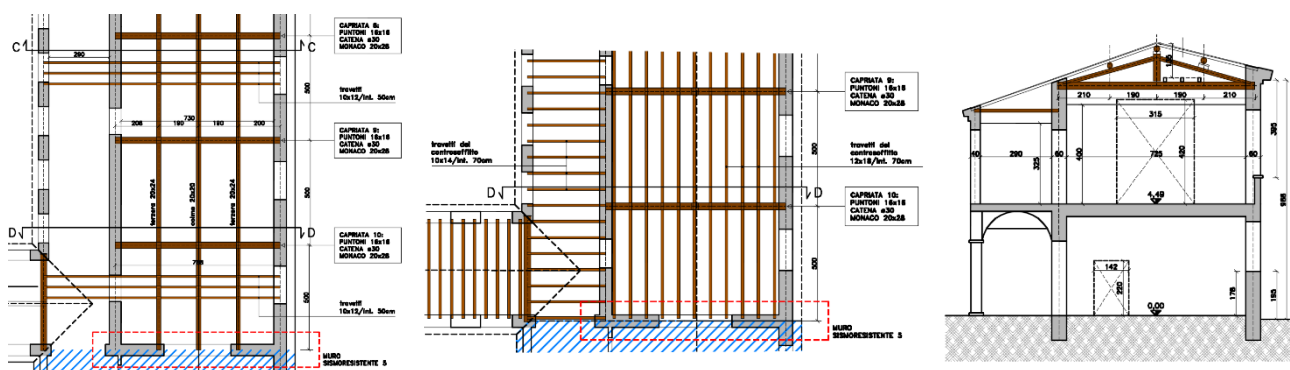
Schema strutturale tetto e controsoffitto zona B (zona est)
